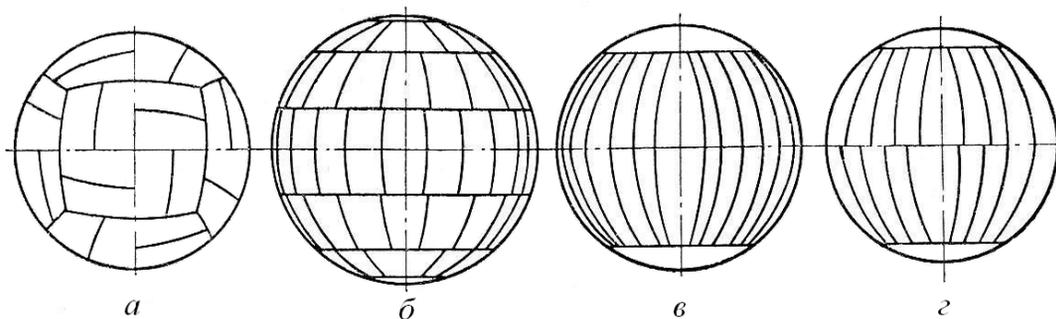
Схемы раскроя корпусов шаровых резервуаров
